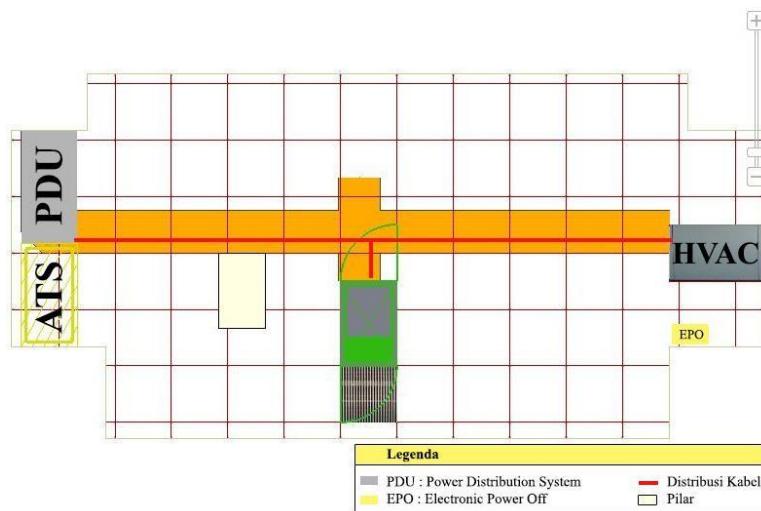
Denah *Data Center* dan Ruangan Pendukung Tampak Atas (*Plan Section*)
